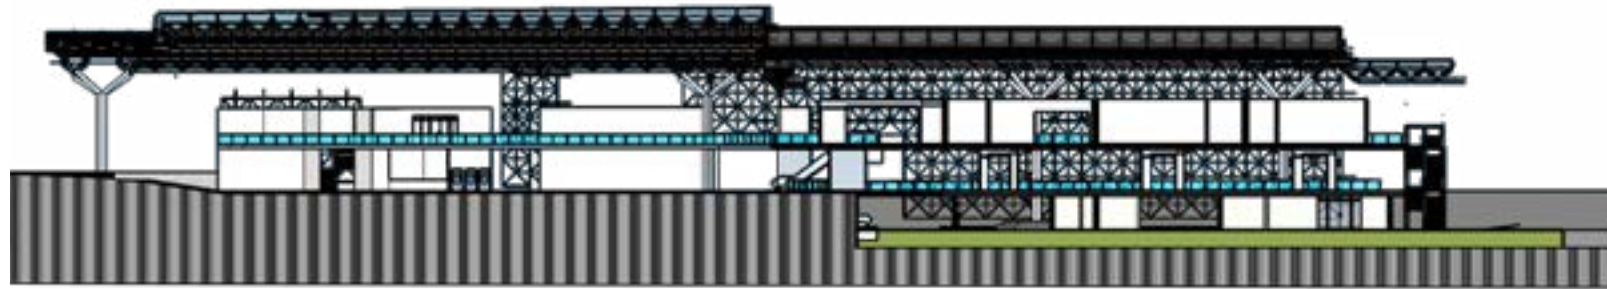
Sánchez, R. (2019). Vista de sección longitudinal.
